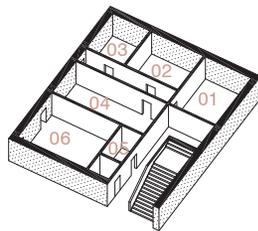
3D Darstellung, Grundrisse Eingangsbereich
